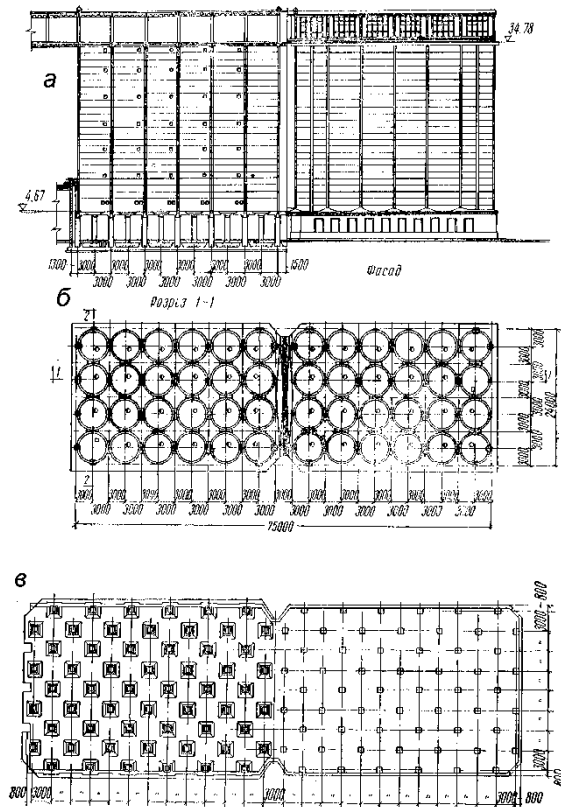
Силосний корпус, збірний із залізобетонних кілець: а- фасад і поздовжній розріз; б-план; в- план підсилосного поверху (справа) і фундаментної плити (зліва)
